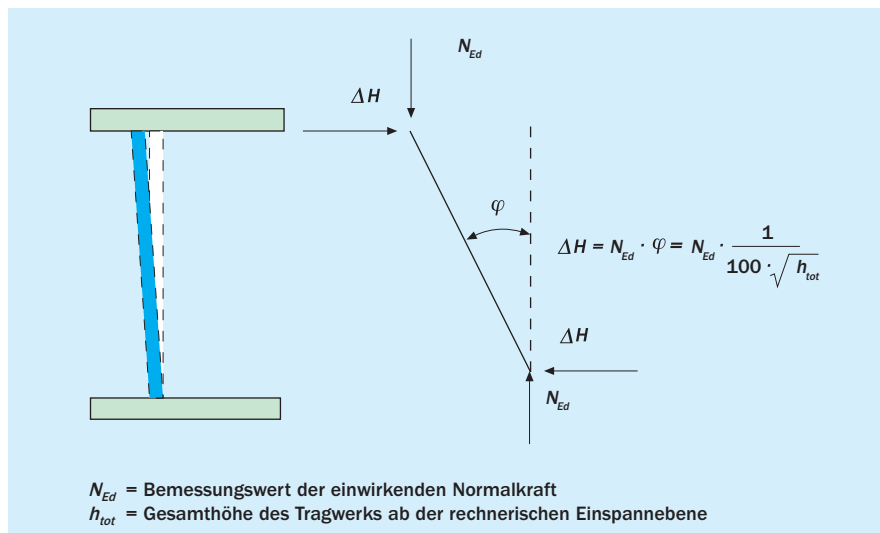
Lotabweichung für den Nachweis der Gebäudeaussteifung
